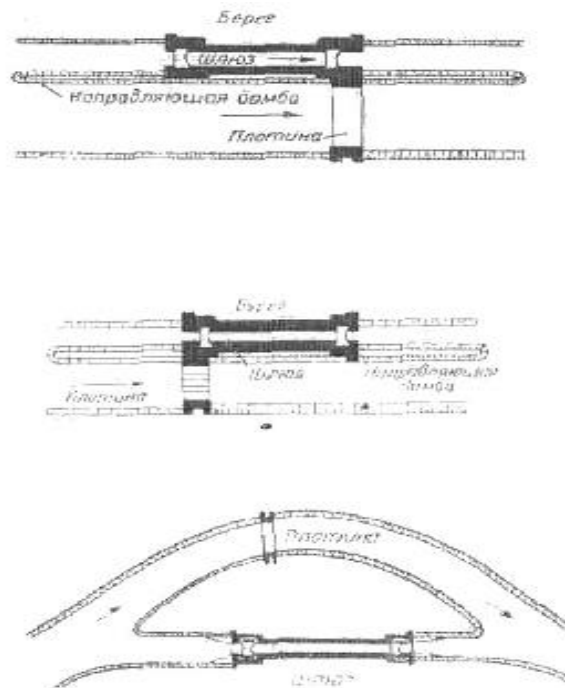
Схеми розташування шлюзу в гідровузлі
